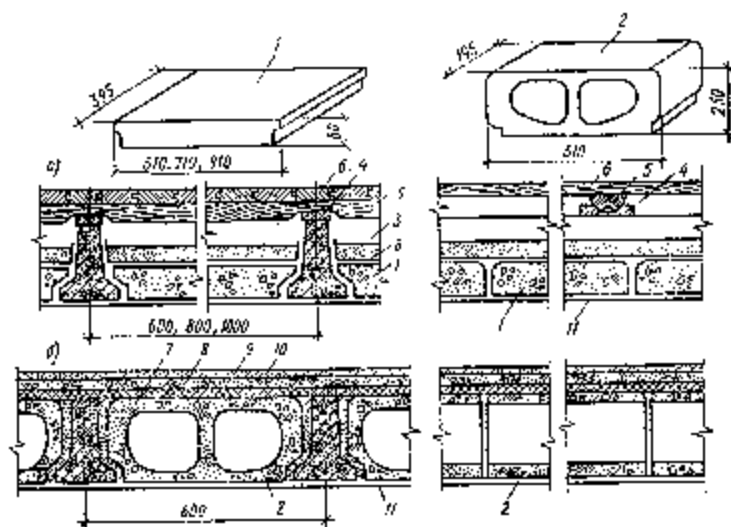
Междуэтажные перекрытия по сборным железобетонным балкам: а – с накатом из плит; б – с заполнением вкладышами; 1 - гипсобетонные плиты; 2 – легкобетонные плиты; 3 – шлак; 4 – звукоизоляционная прокладка; 5 – лага; 6 – дощатый пол; 7 – отверстие; 8 – утеплитель; 9 – легкий бетон; 10 - цементно-песчаный раствор; 11 - затирка
